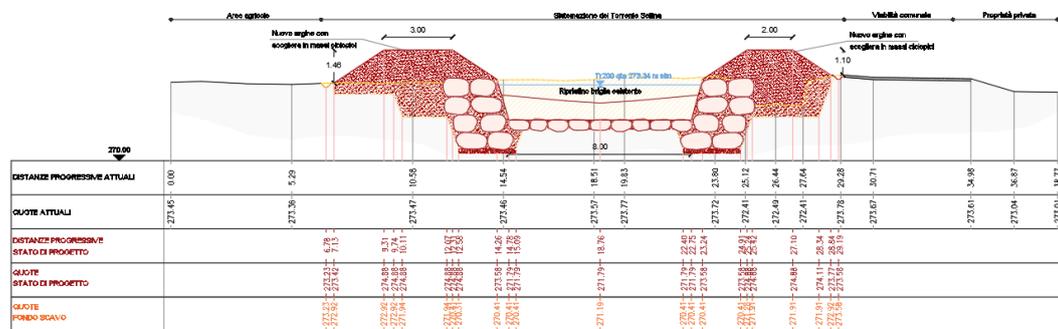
estratto della tavola T03b del progetto - Sezione 2210 - briglia
